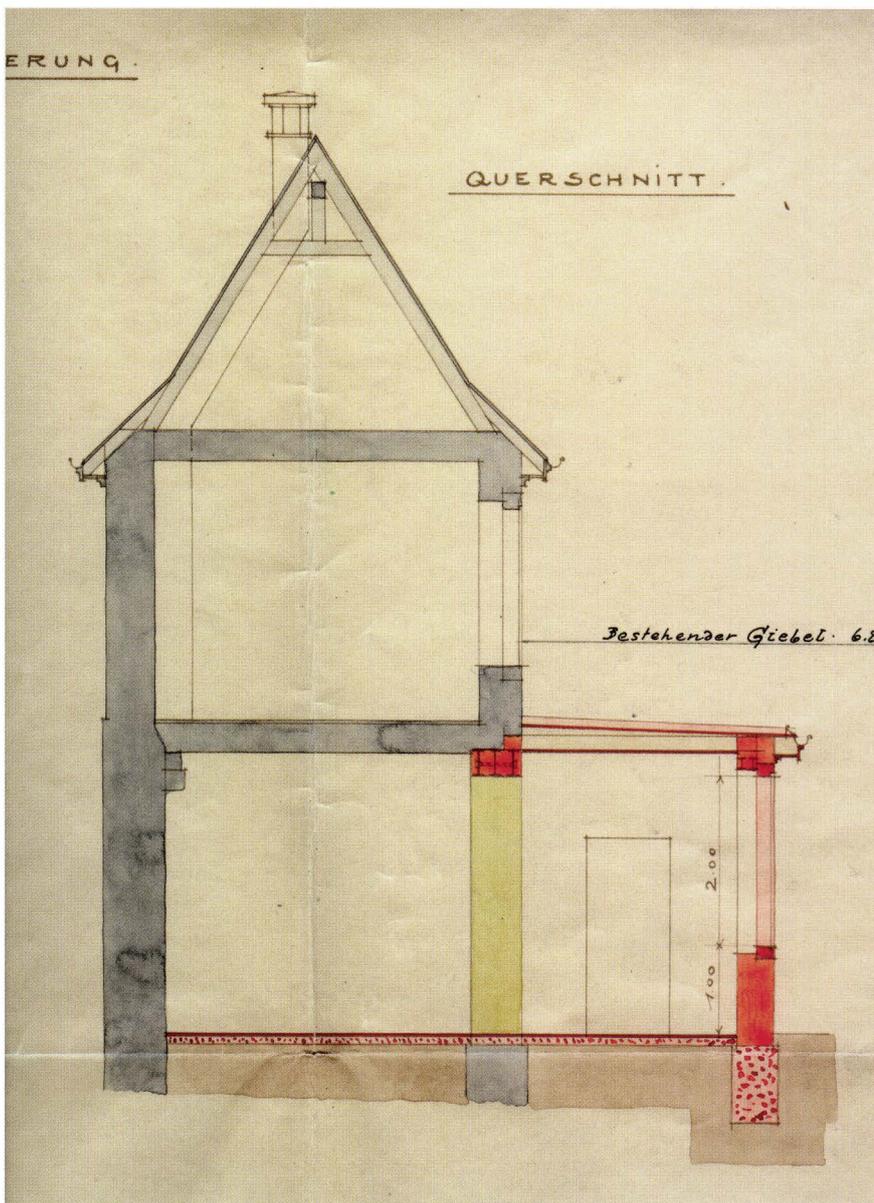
Nadelberg 11A. Schnitt durch das Gebäude. Der Plan von 1908 gehört zu einem Baubegehren für das «Stadtuhrmacherlokal». Er zeigt den EG-Ausbau, der die östliche Fassadenhälfte im Hof durchbricht und einen eingeschossigen Anbau anfügt. Der Schnitt durch Haus und Dachwerk ist relativ schematisch gehalten. Der First des einfachen Sparrendachs ist mit kurzen Firststielen auf Hahnenbalken abgestützt. Die Fusspunkte zeigen keine Detailsausbildung (siehe Abb. 7). Das Kamin ist inzwischen abgebrochen. – StaBS, Bauplanausgabe, Baubegehren Nr. 378.
